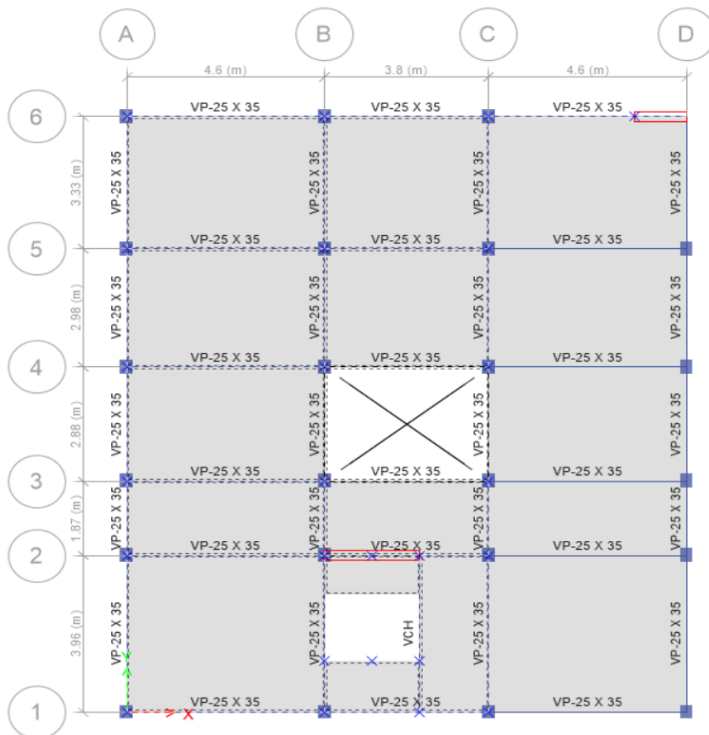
Plano con los elementos estructurales de la edificación 4 pisos con placa (Etabs)
